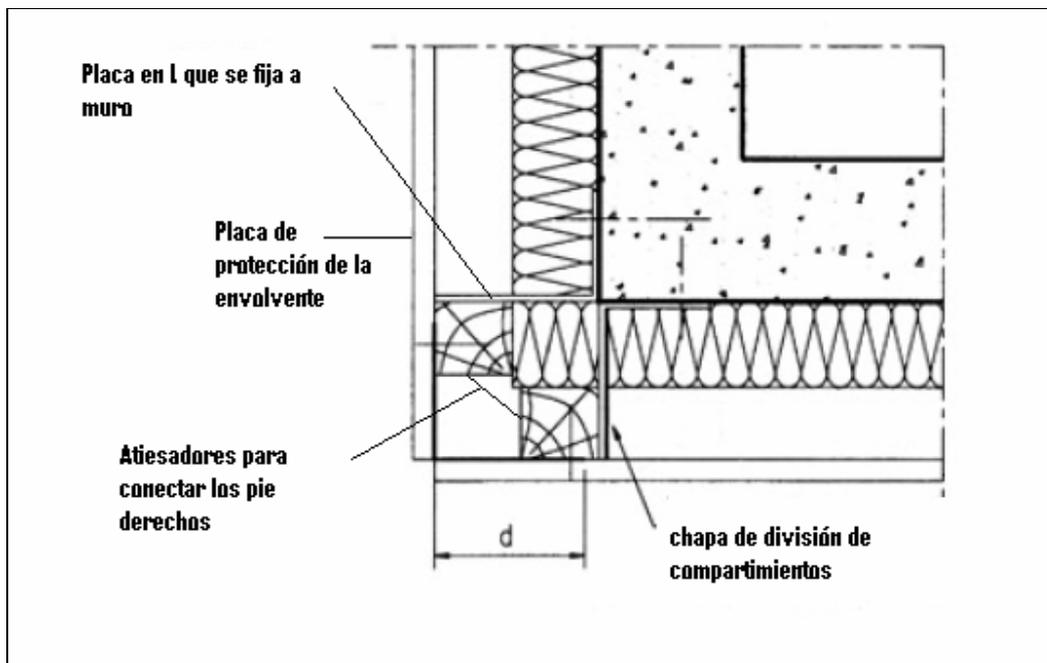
Placas en L que se coloca fija al muro en toda la vertical y a la estructura.
